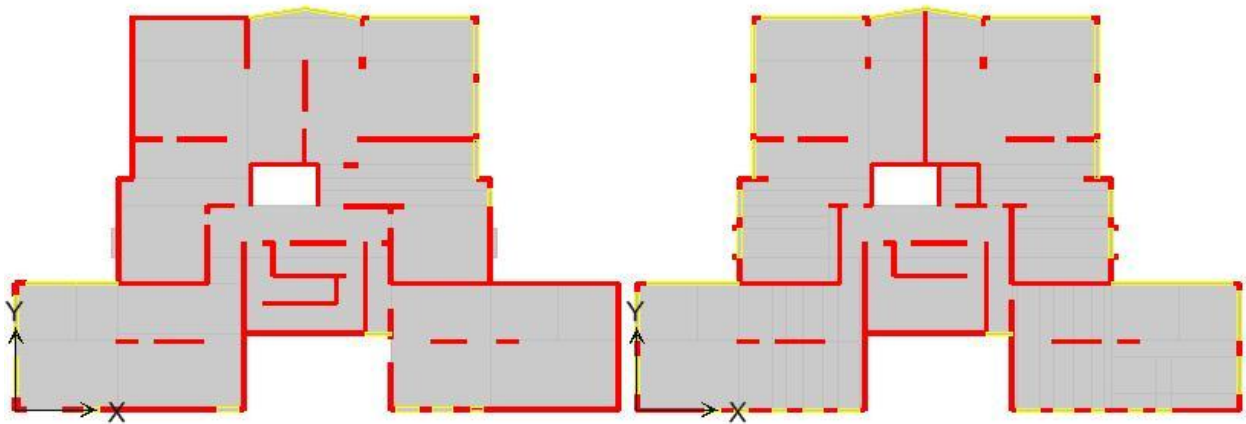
Planta primer piso (izquierda) y piso tipo (derecha) edificio H6
